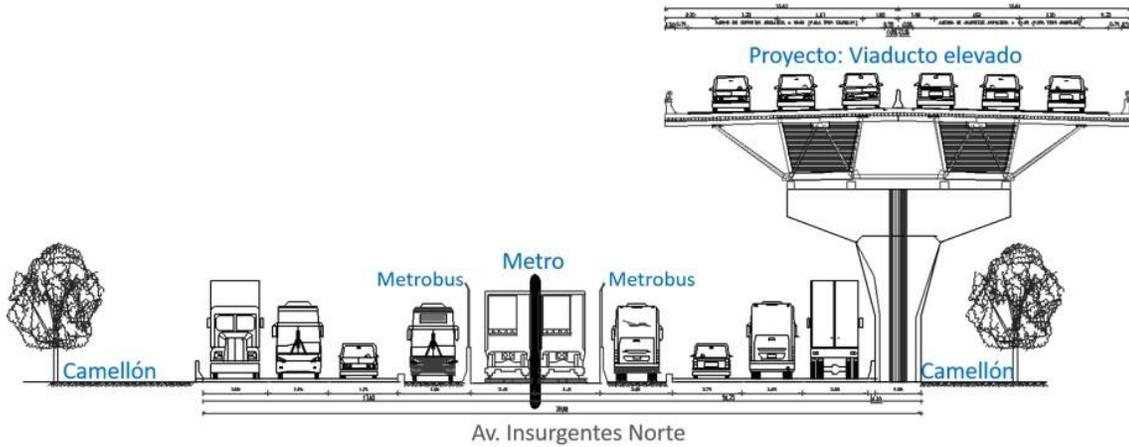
Perfil esquemático del proyecto en Avenida Insurgentes Norte.
